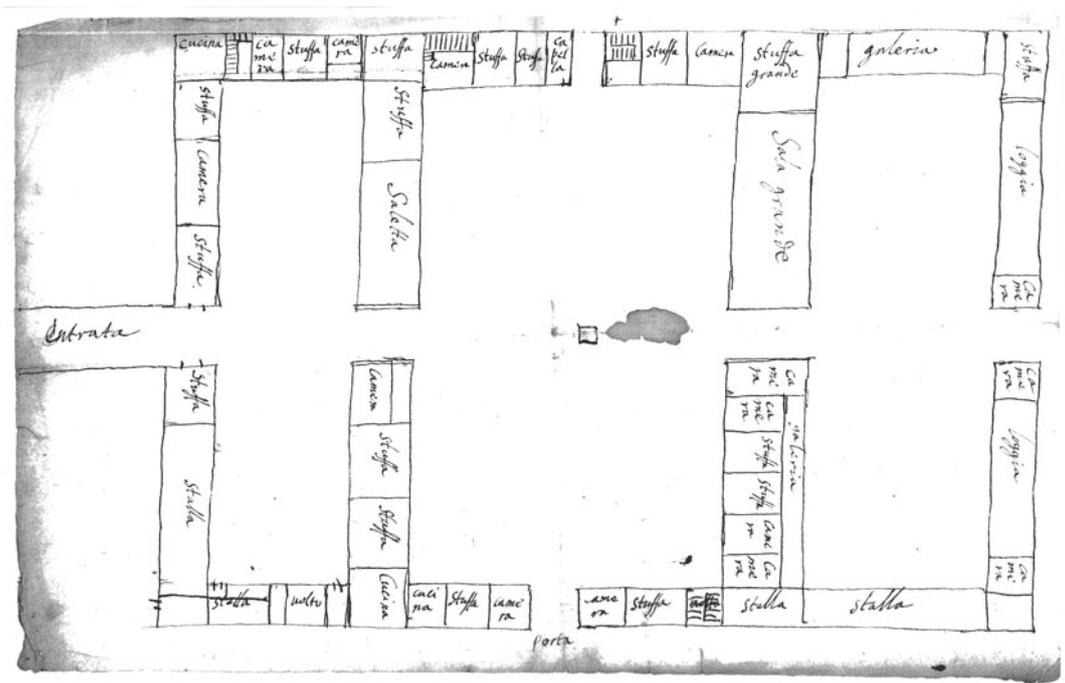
Grundriss des Gebäudes im Taborgarten
